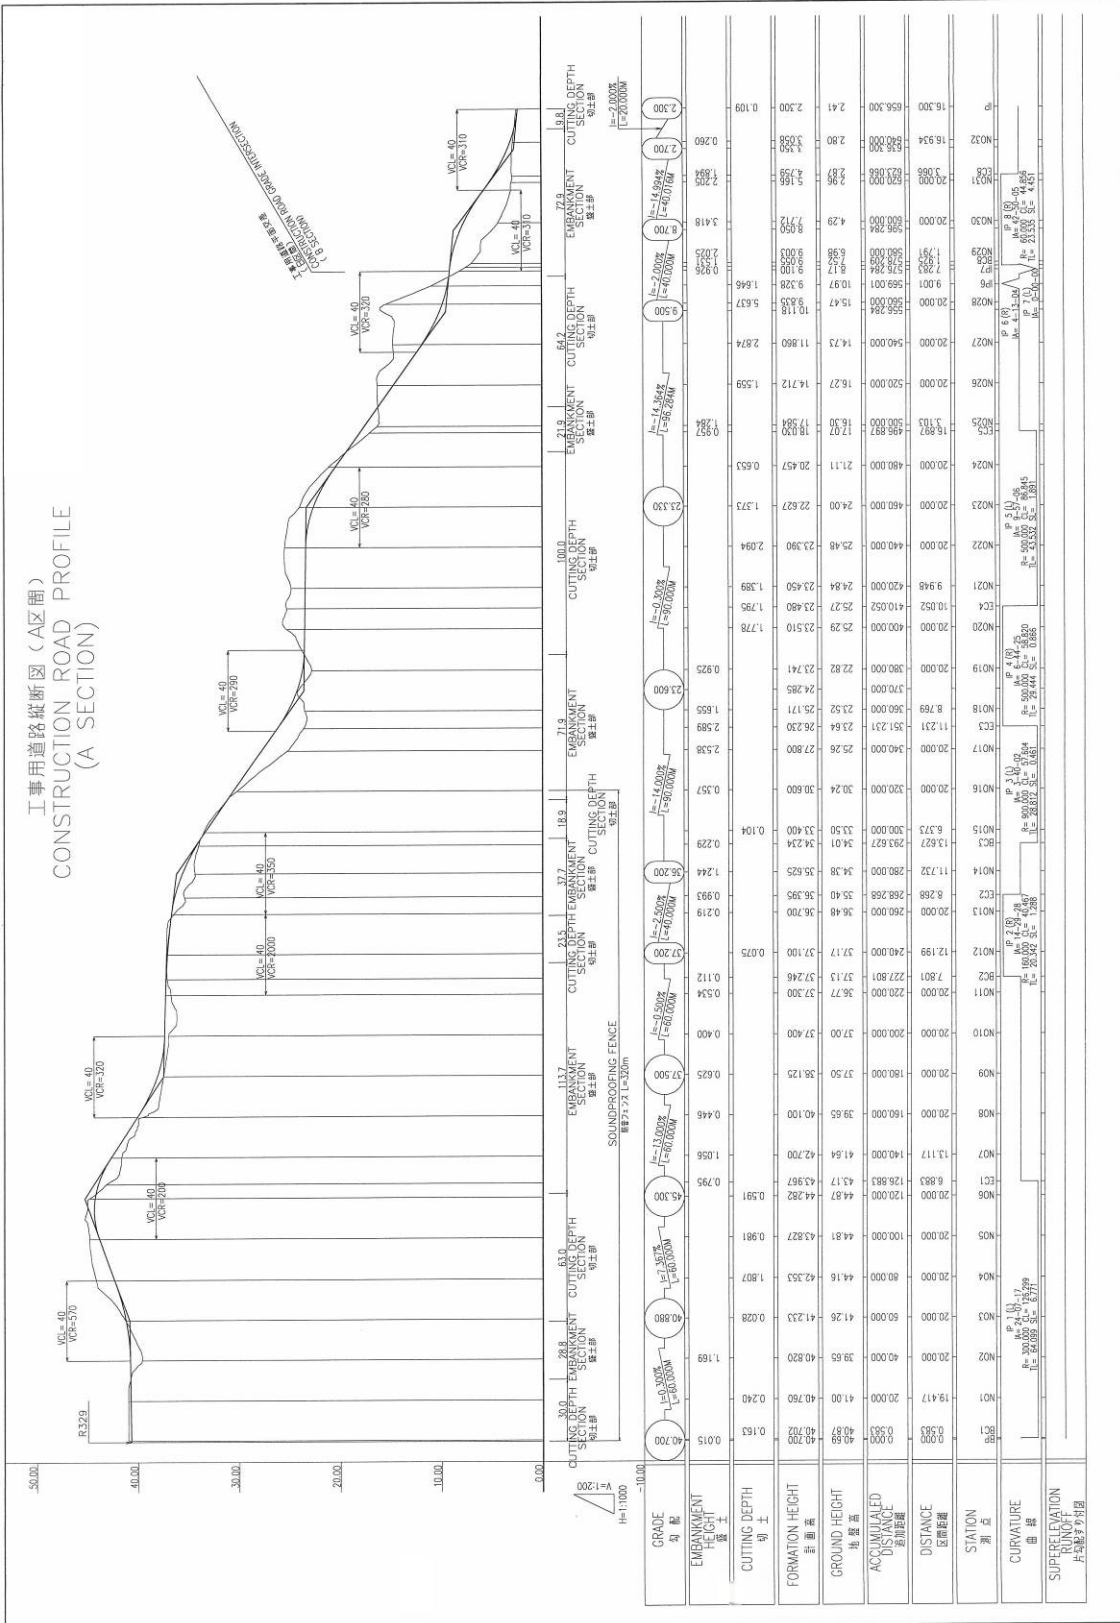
(1) 工事用仮設道路縦断面図 (A区間)
